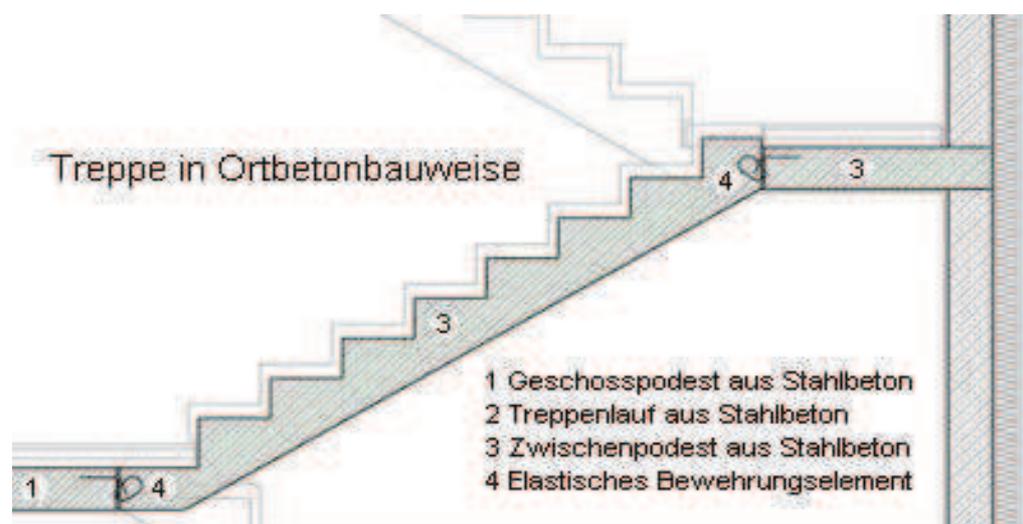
, Beispiel für den Aufbau einer Stahlbetontreppe
